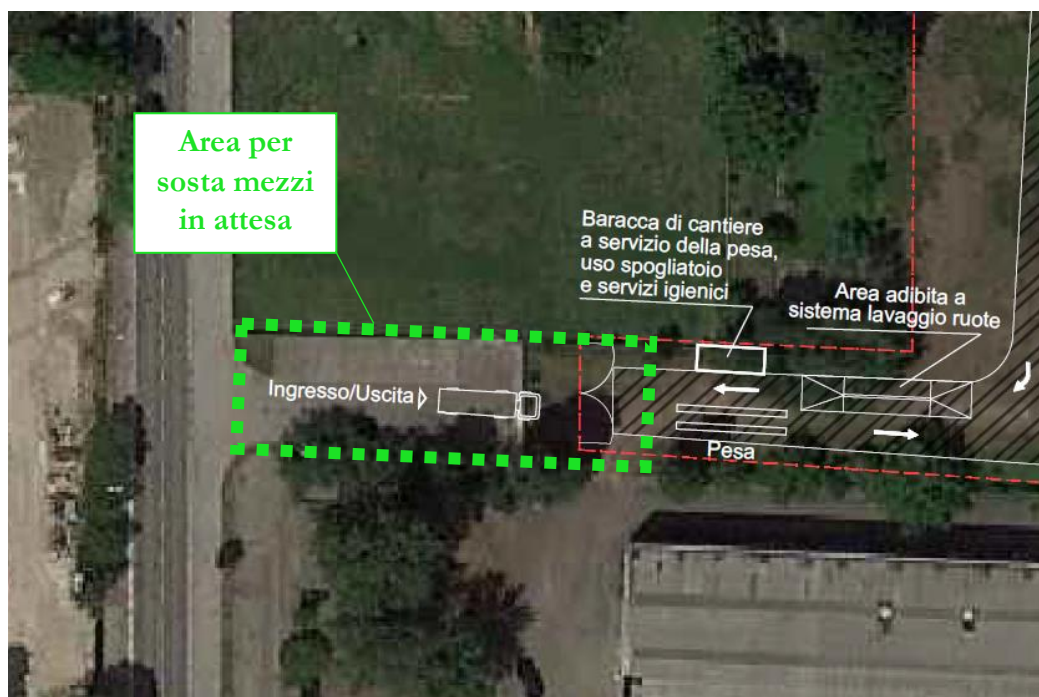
Layout impianto di recupero rifiuti, stralcio elaborato 25-C021_GEN.01.04.R0_ Layout impianto di recupero rifiuti – dettaglio area di ingresso
